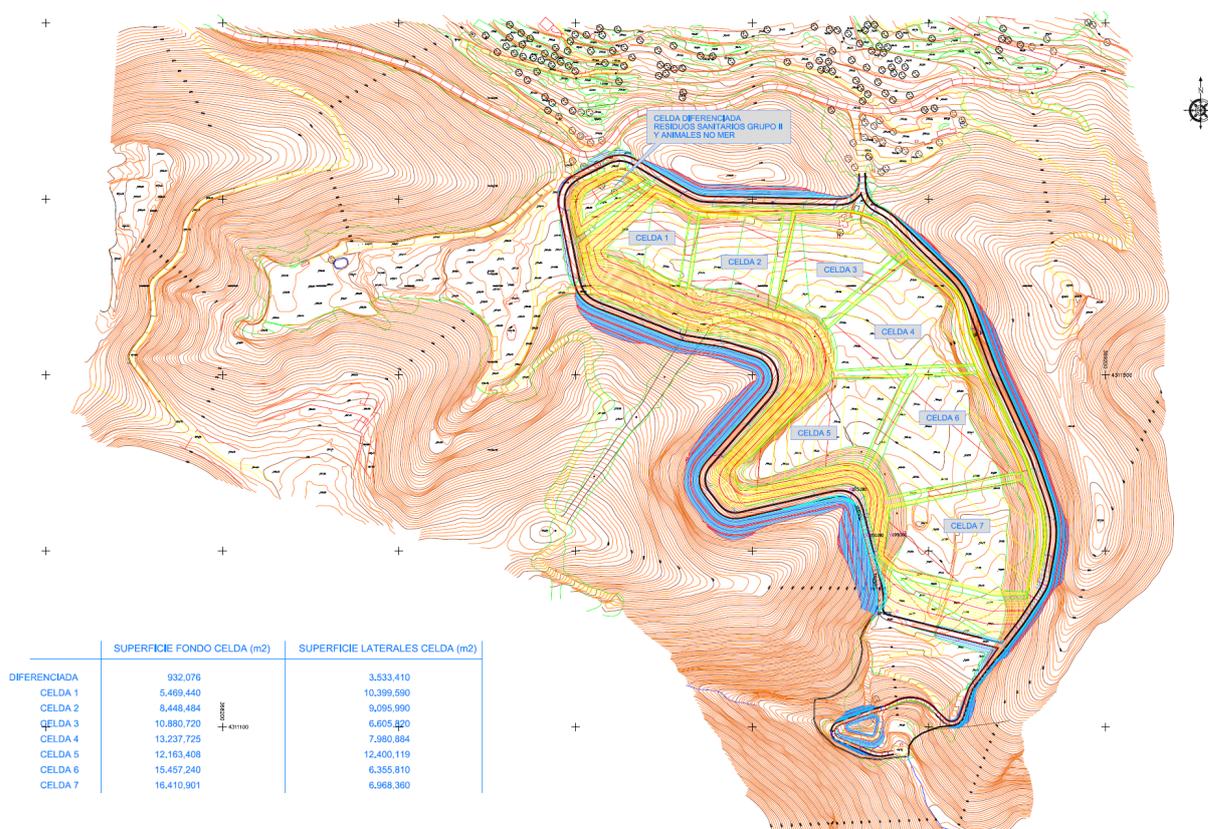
Imagen del proyecto de construcción del vertedero.
